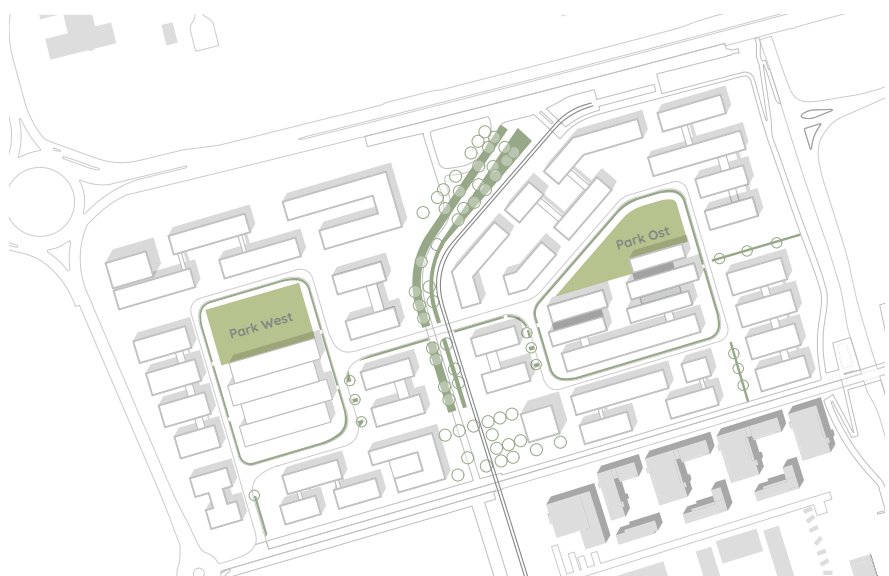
Öffentliche Parkflächen („Brillengläser“)
